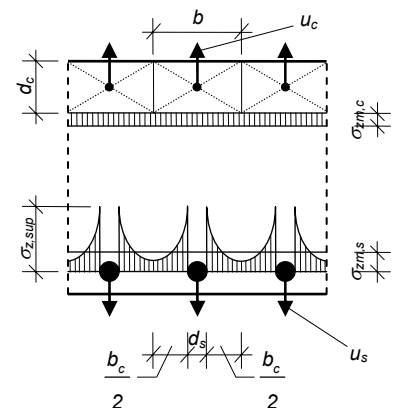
Querschnitt des gekrümmten Balkens: Betonzugspannungen σ_z
